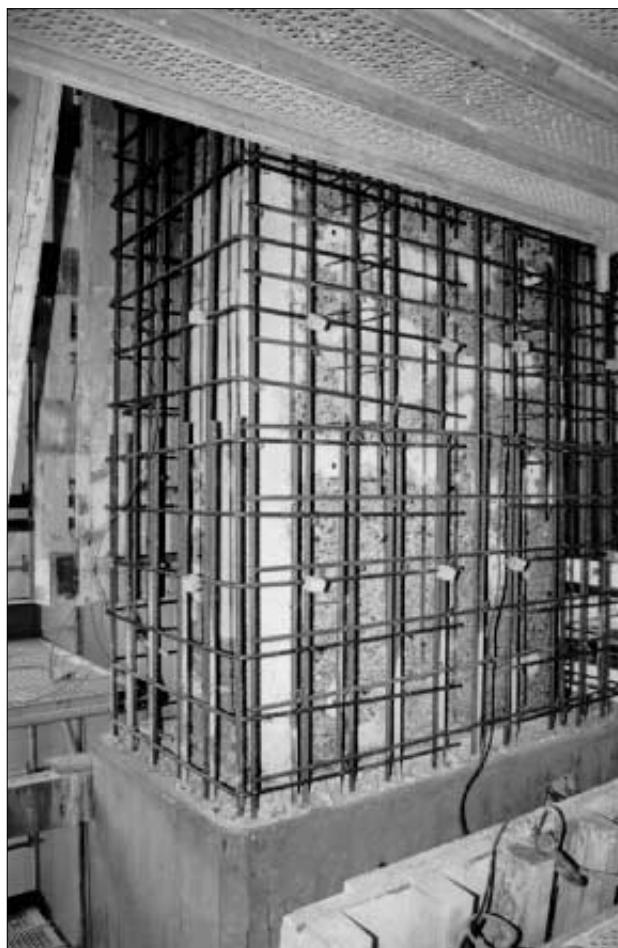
Renforcement d'un pilier (photo: Service des travaux publics, canton d'Uri).
